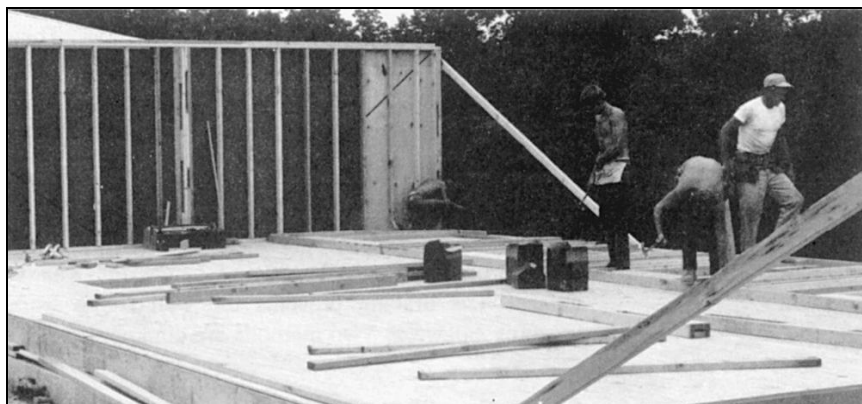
Крепление гвоздями стоек рамных стеновых конструкций
